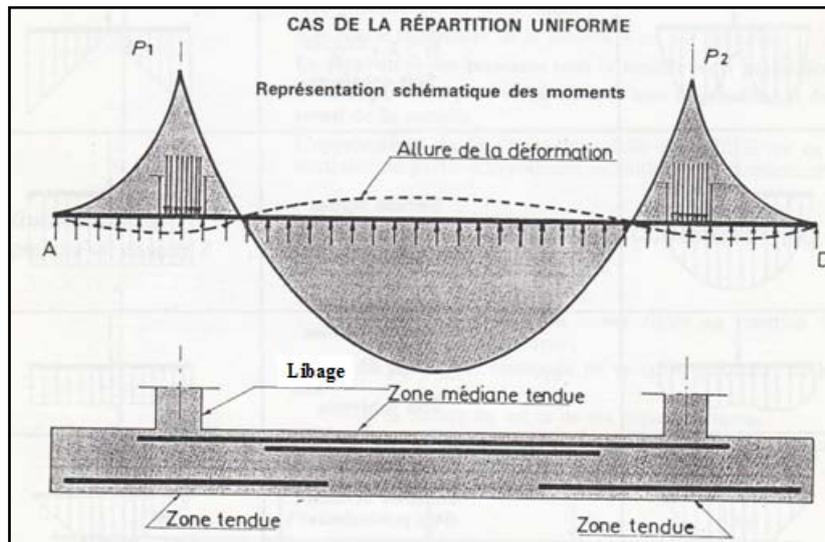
Schéma de principe du fonctionnement d'une semelle filante et disposition des aciers
